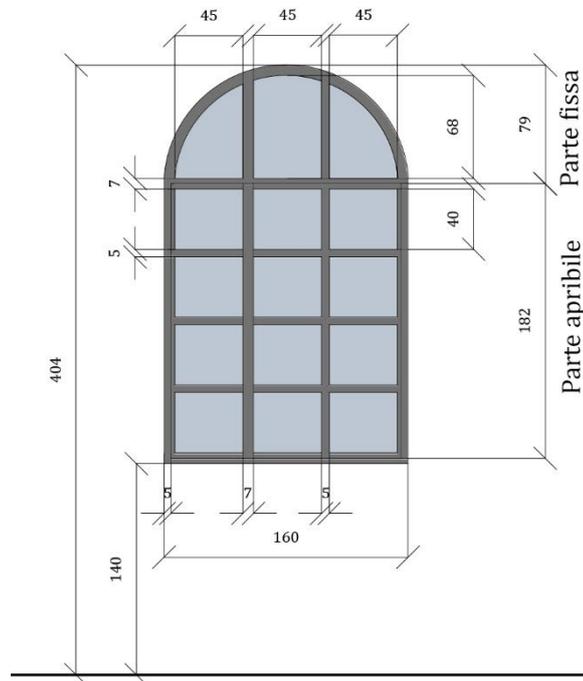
Prospetto in scala 1:50 della tipologia di aperture caratteristica del primo piano.
